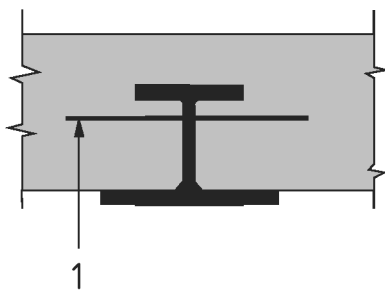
Viga mixta formada por viga de acero no embebida en hormigón
